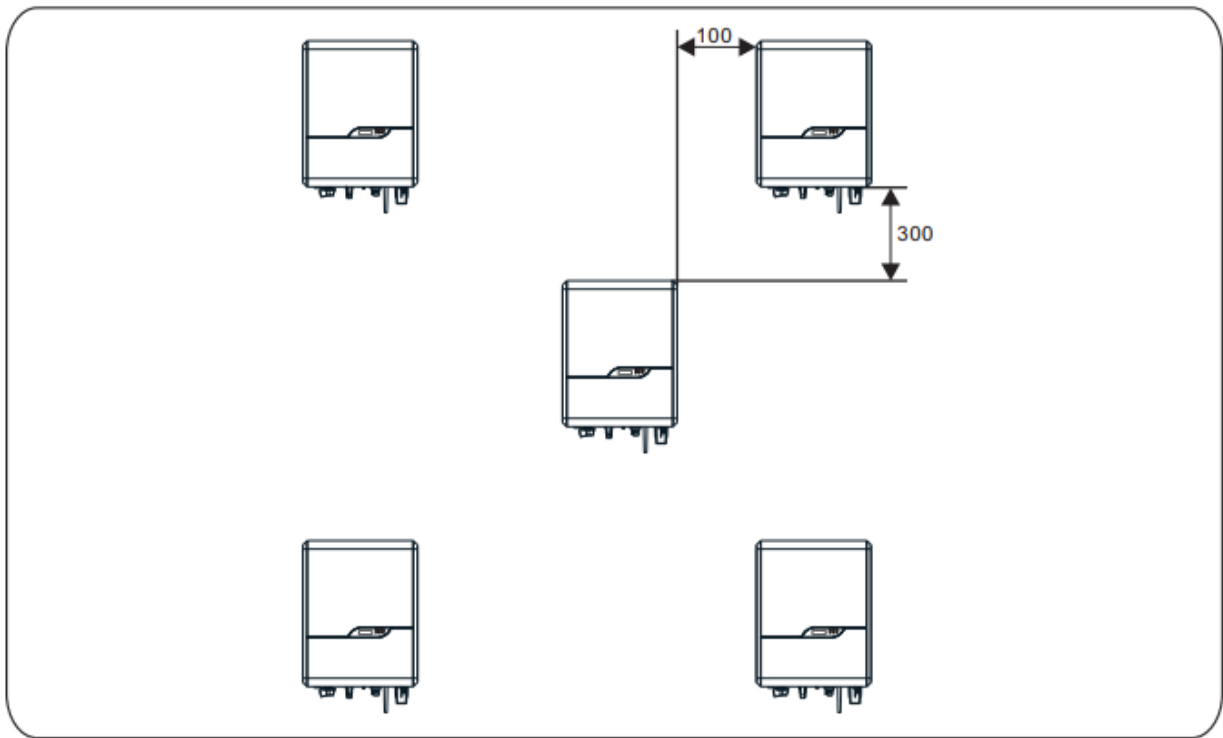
Installazione in modalità triangolo (unità: mm)
